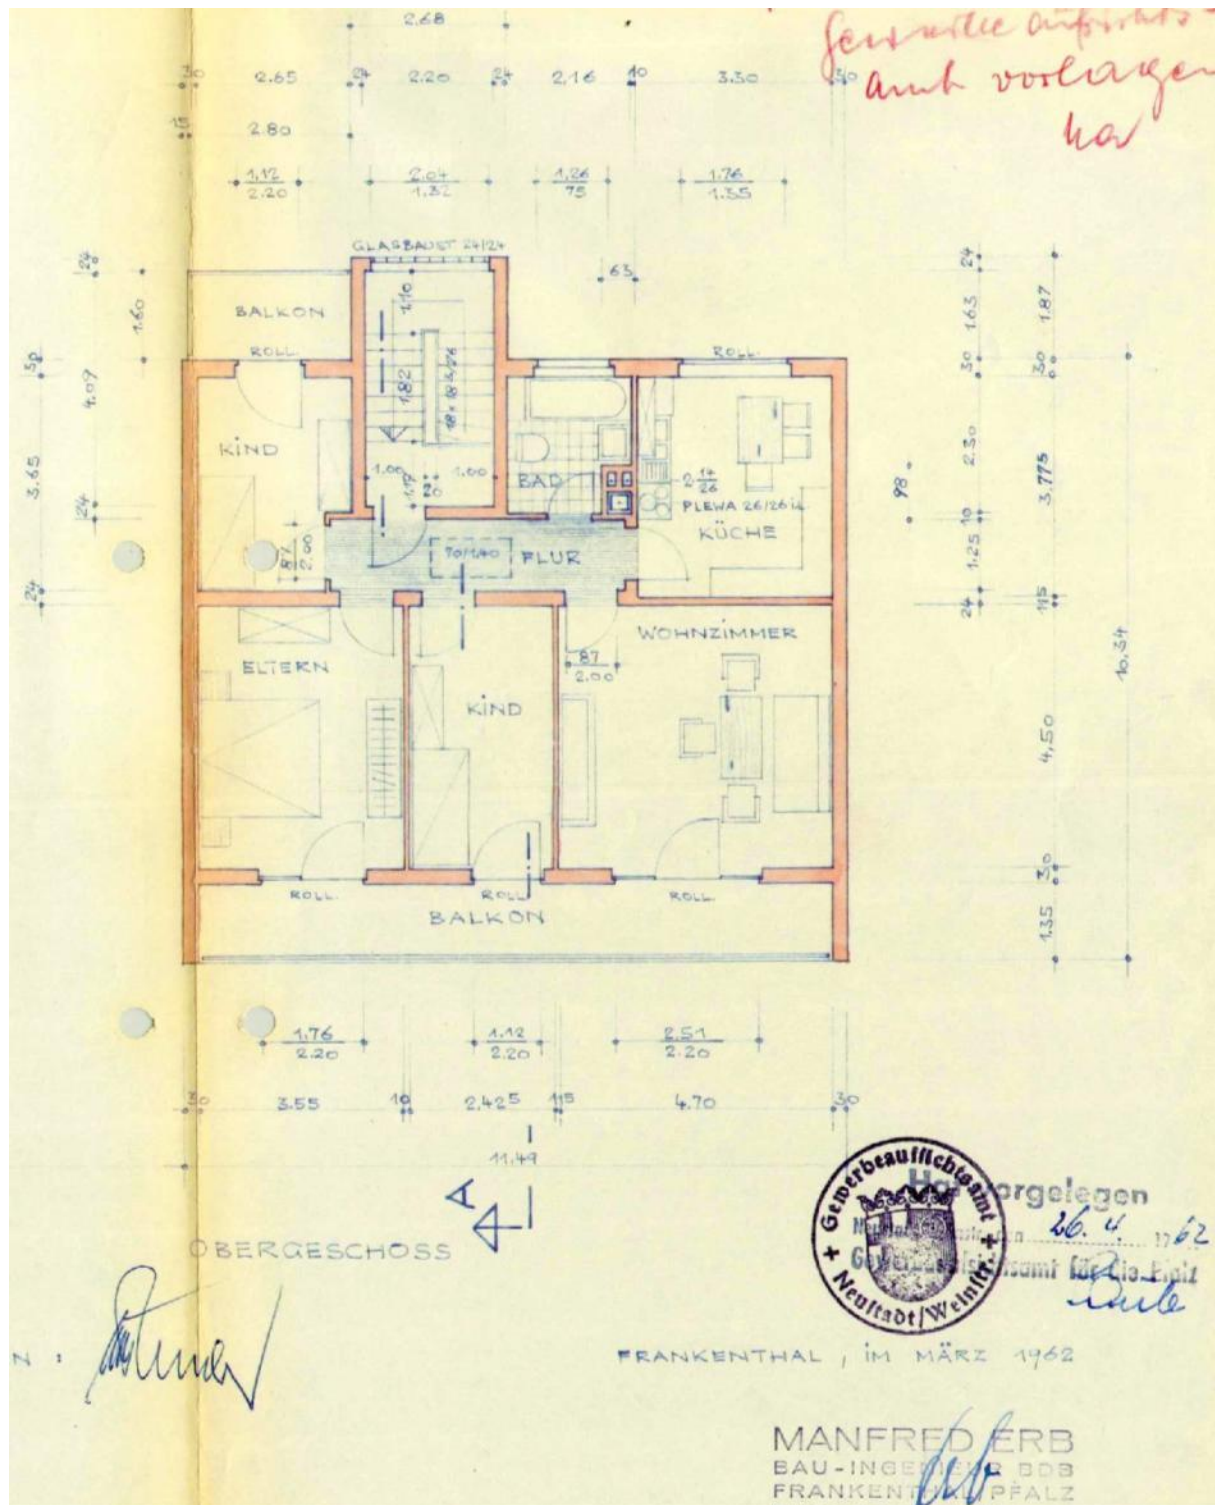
Grundrissplan Obergeschoss des Ursprungsgebäudes (aus Bauakte 1962)
